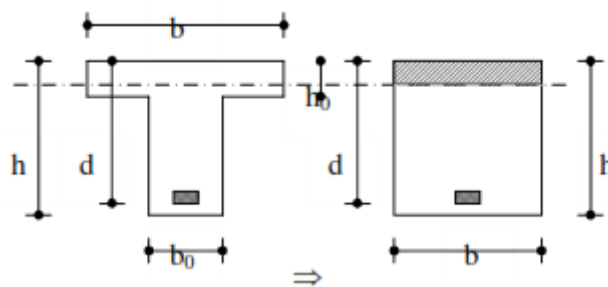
Coupe de Section Rectangulaire et Section en T
